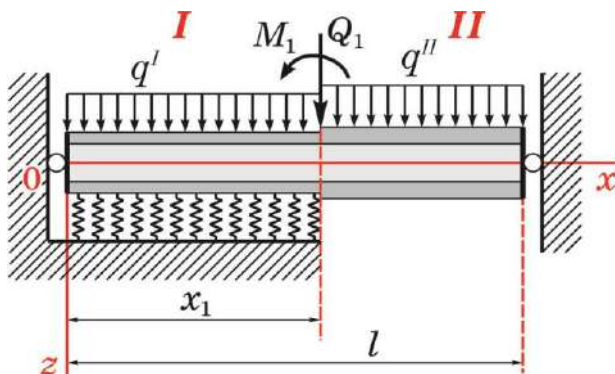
Расчетная схема стержня с шарнирным закреплением торцов и жесткими диафрагмами
